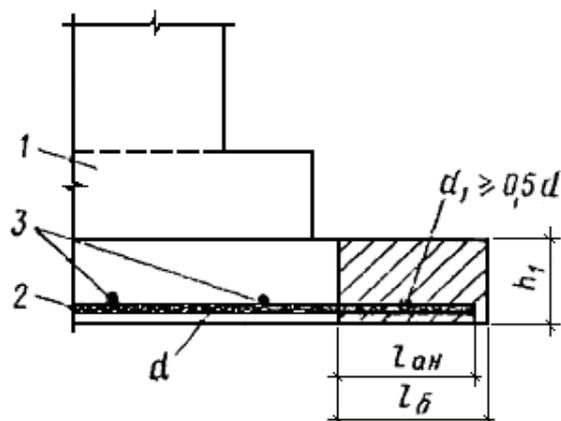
К проверке анкеровки рабочей арматуры фундамента [2, рис. 52]
